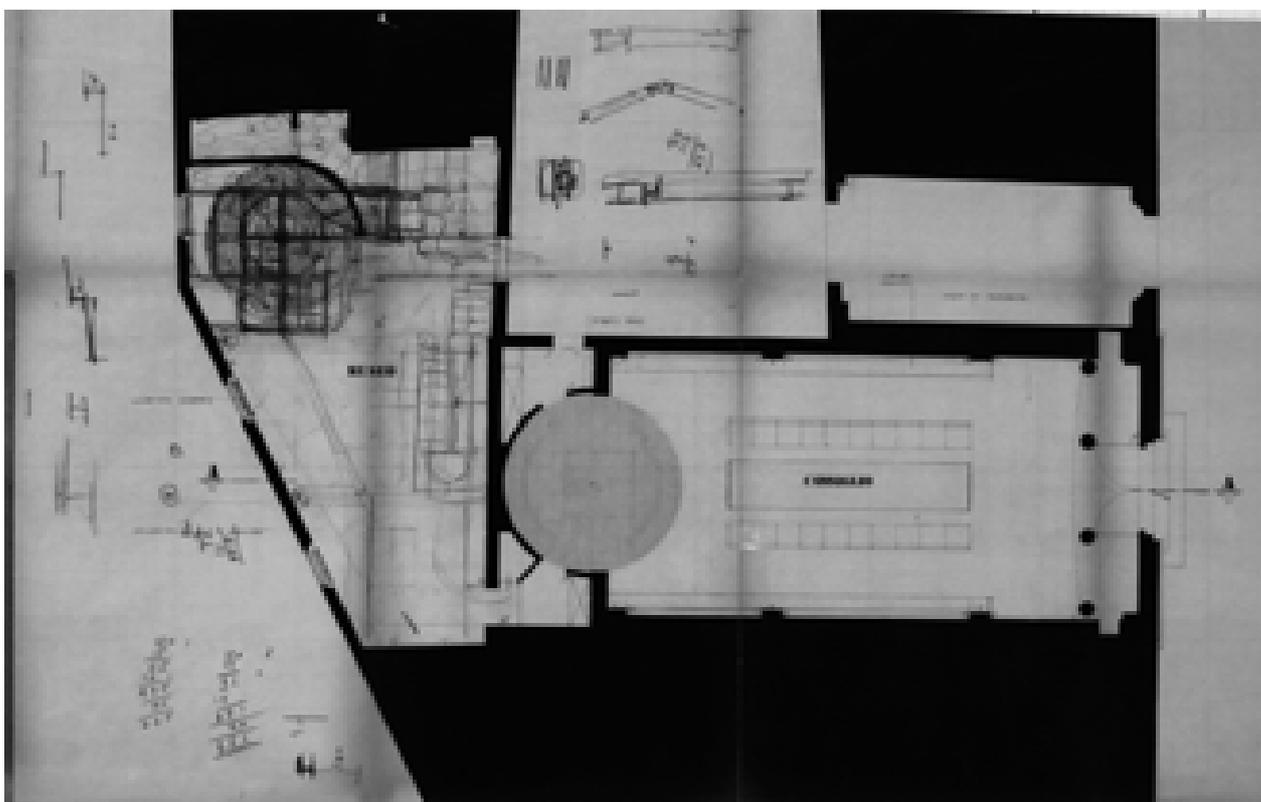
Pianta quota +0,00– Stato di progetto – 10/11/1980 (AABS-94.047)
